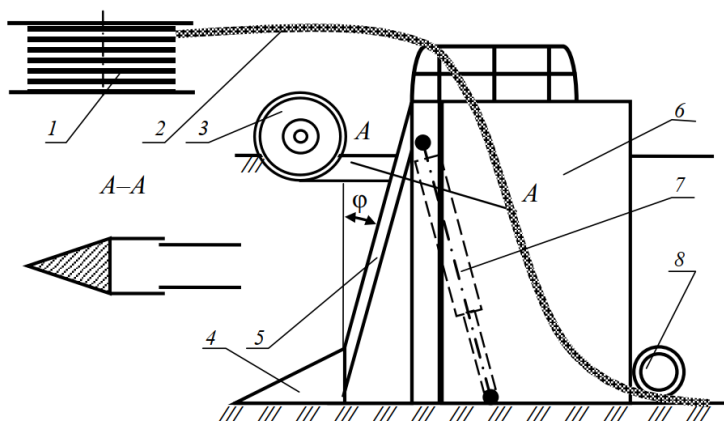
Схема рабочего органа дреноукладчика МД-12: 1 – барабан; 2 – дренажная труба; 3 – дисковый дернорез; 4 – носовина; 5 – нож; 6 – щиты боковые; 7 – гидроцилиндр рабочего органа; 8 – прижимной ролик
